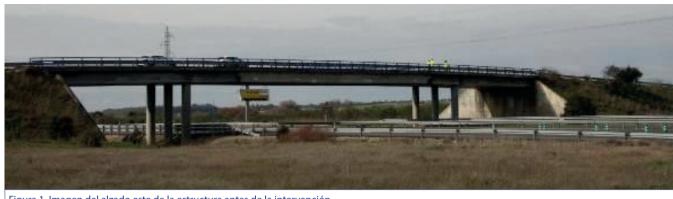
Imagen del alzado este de la estructura antes de la intervención
